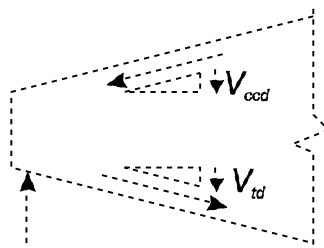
Составляющие поперечных усилий для элементов с наклонными поясами
